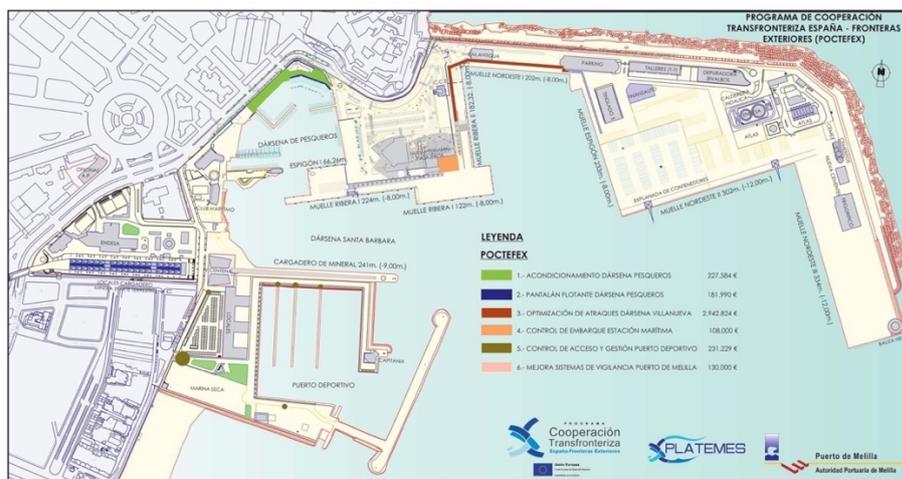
Plano general del puerto de Melilla (Autoridad Portuaria de Melilla, 2023)
